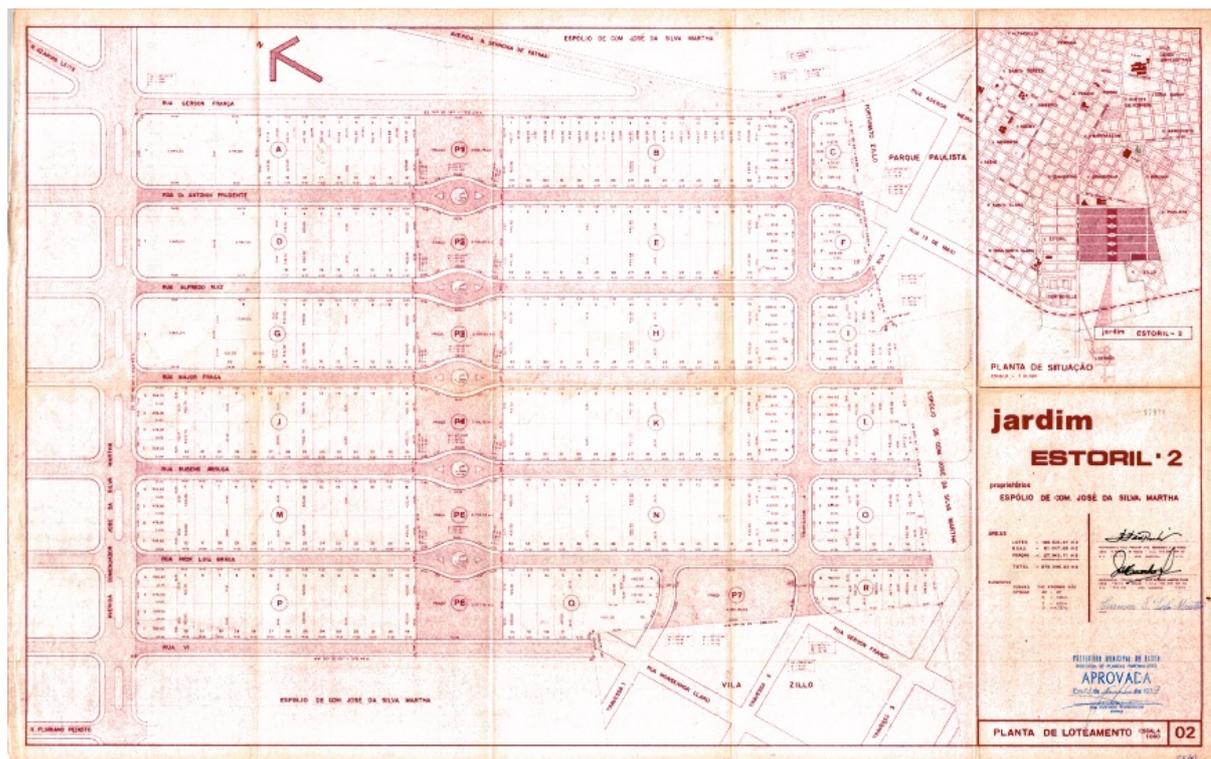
Planta do loteamento Jardim Estoril 2, aprovada em 1977.
